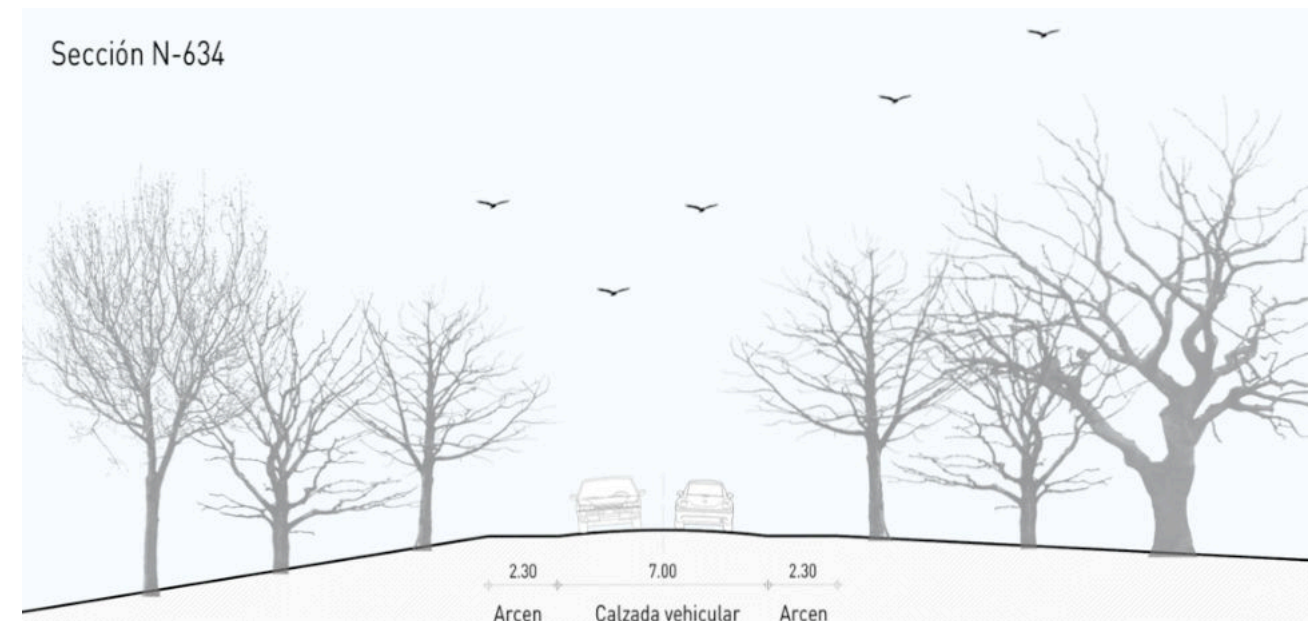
Sección N-634 en dirección a Argüelles (sección 4)
